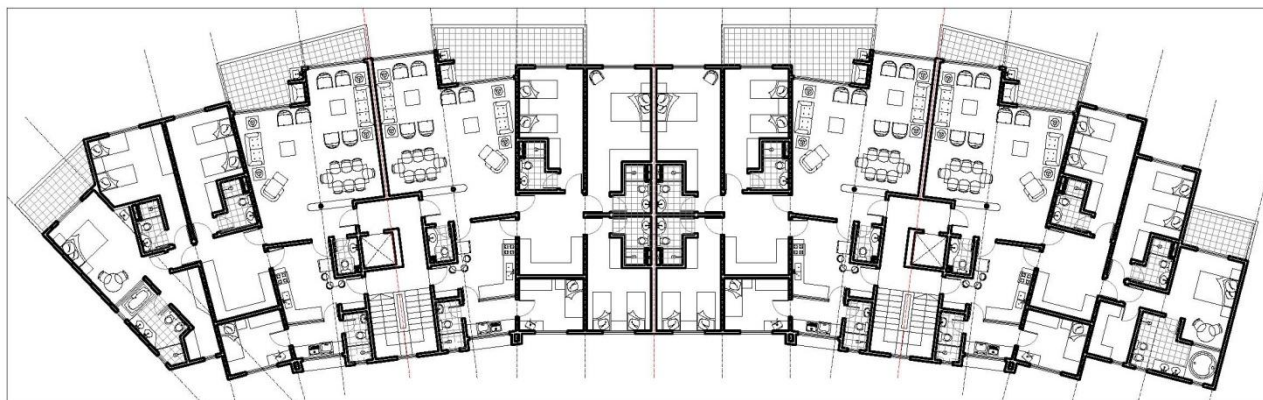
Planta baixa do pavimento tipo do bloco 02.
